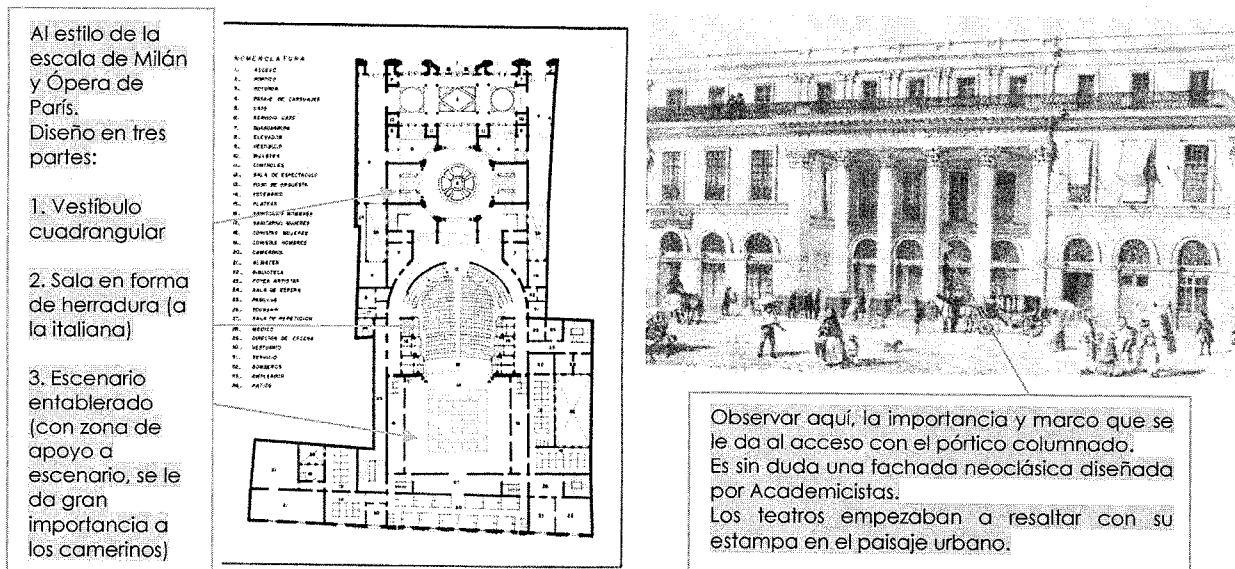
Izquierda: Planta original del teatro de Santa Ana, 1842.
